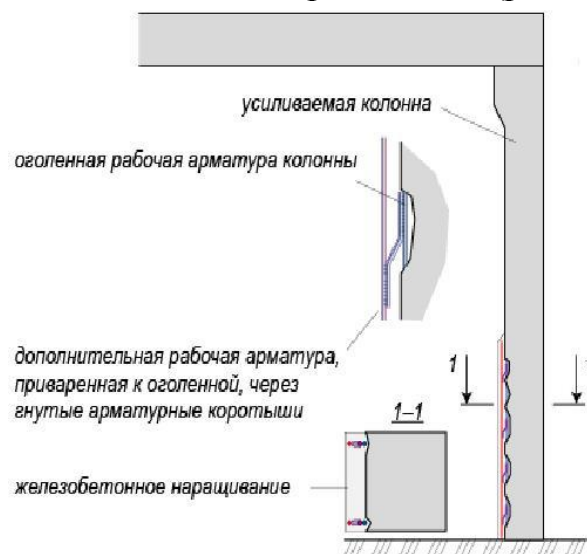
Устройство железобетонного наращивания при усилении железобетонной колонны
